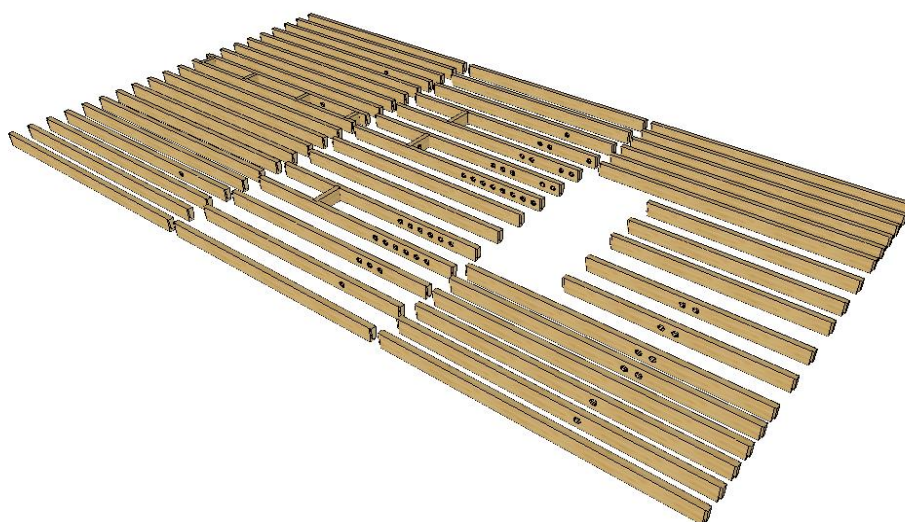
Določitev lastnosti elementa v sklopu strešne konstrukcije
